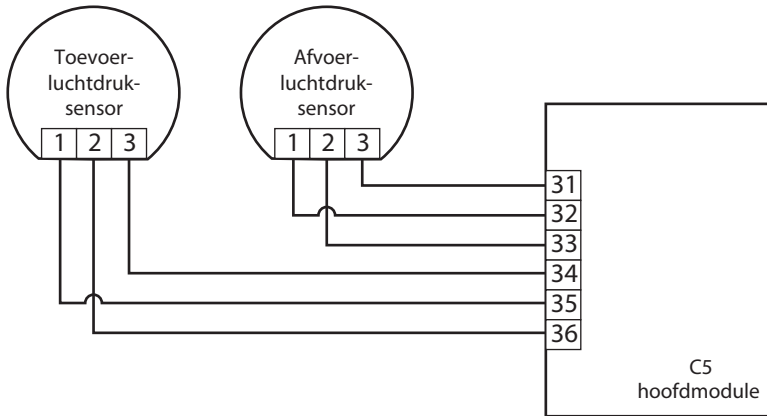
Aansluitschema druksensor voor C5-automatisering
